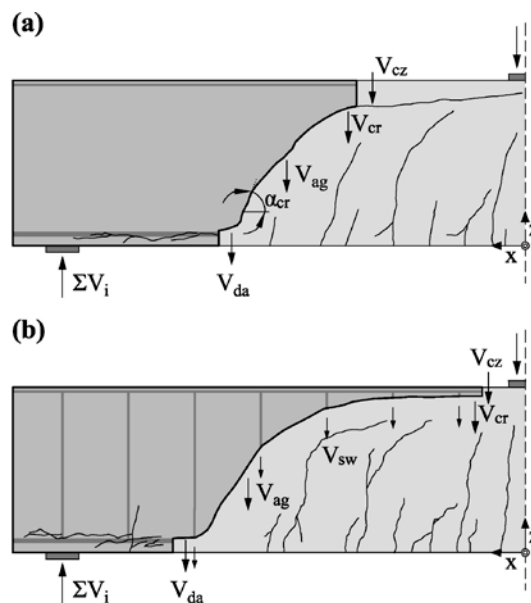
Querkrafttragmechanismen bei Stahlbetonträgern: (a) ohne Schubbewehrung (b) mit Schubbewehrung
